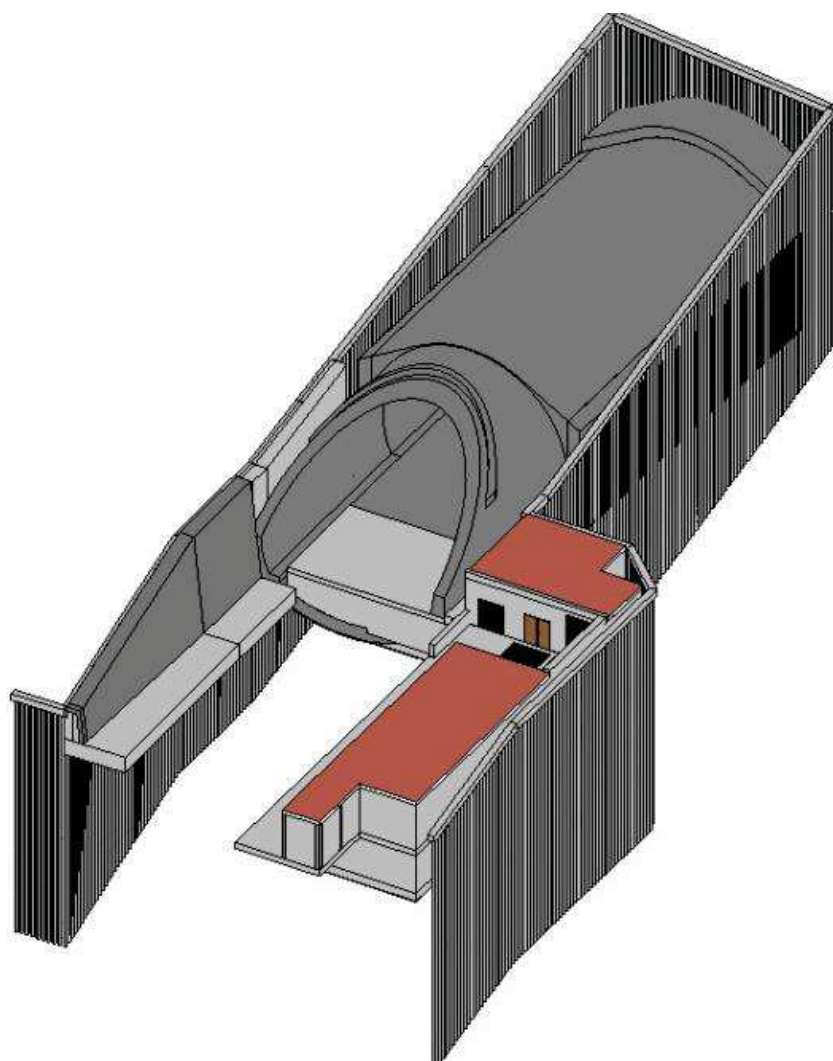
Imbocco Sud Galleria Montebonello – Planimetria in fase definitiva
